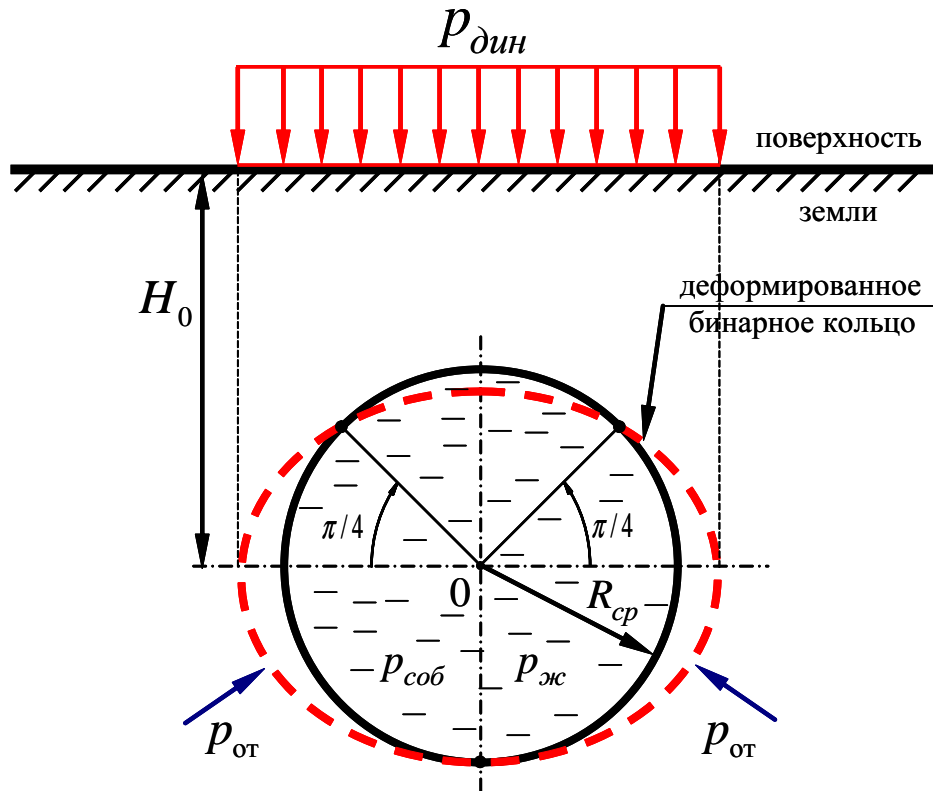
Силовое нагружение подземного стеклопластикового трубопровода
